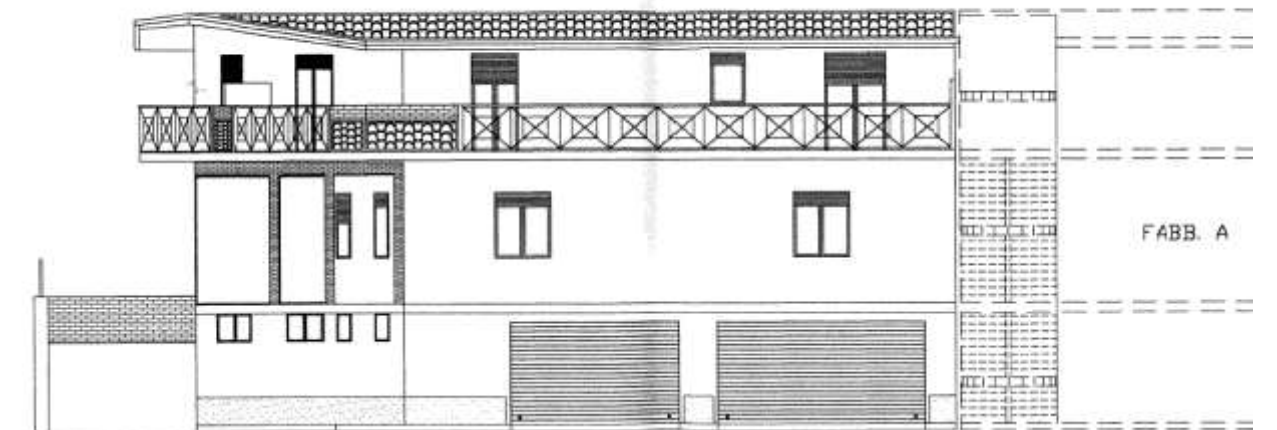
Stralcio TAVOLA 3 di cui al Permesso di Costruire n.25 del 20/11/2004 – Pianta e prospetti
